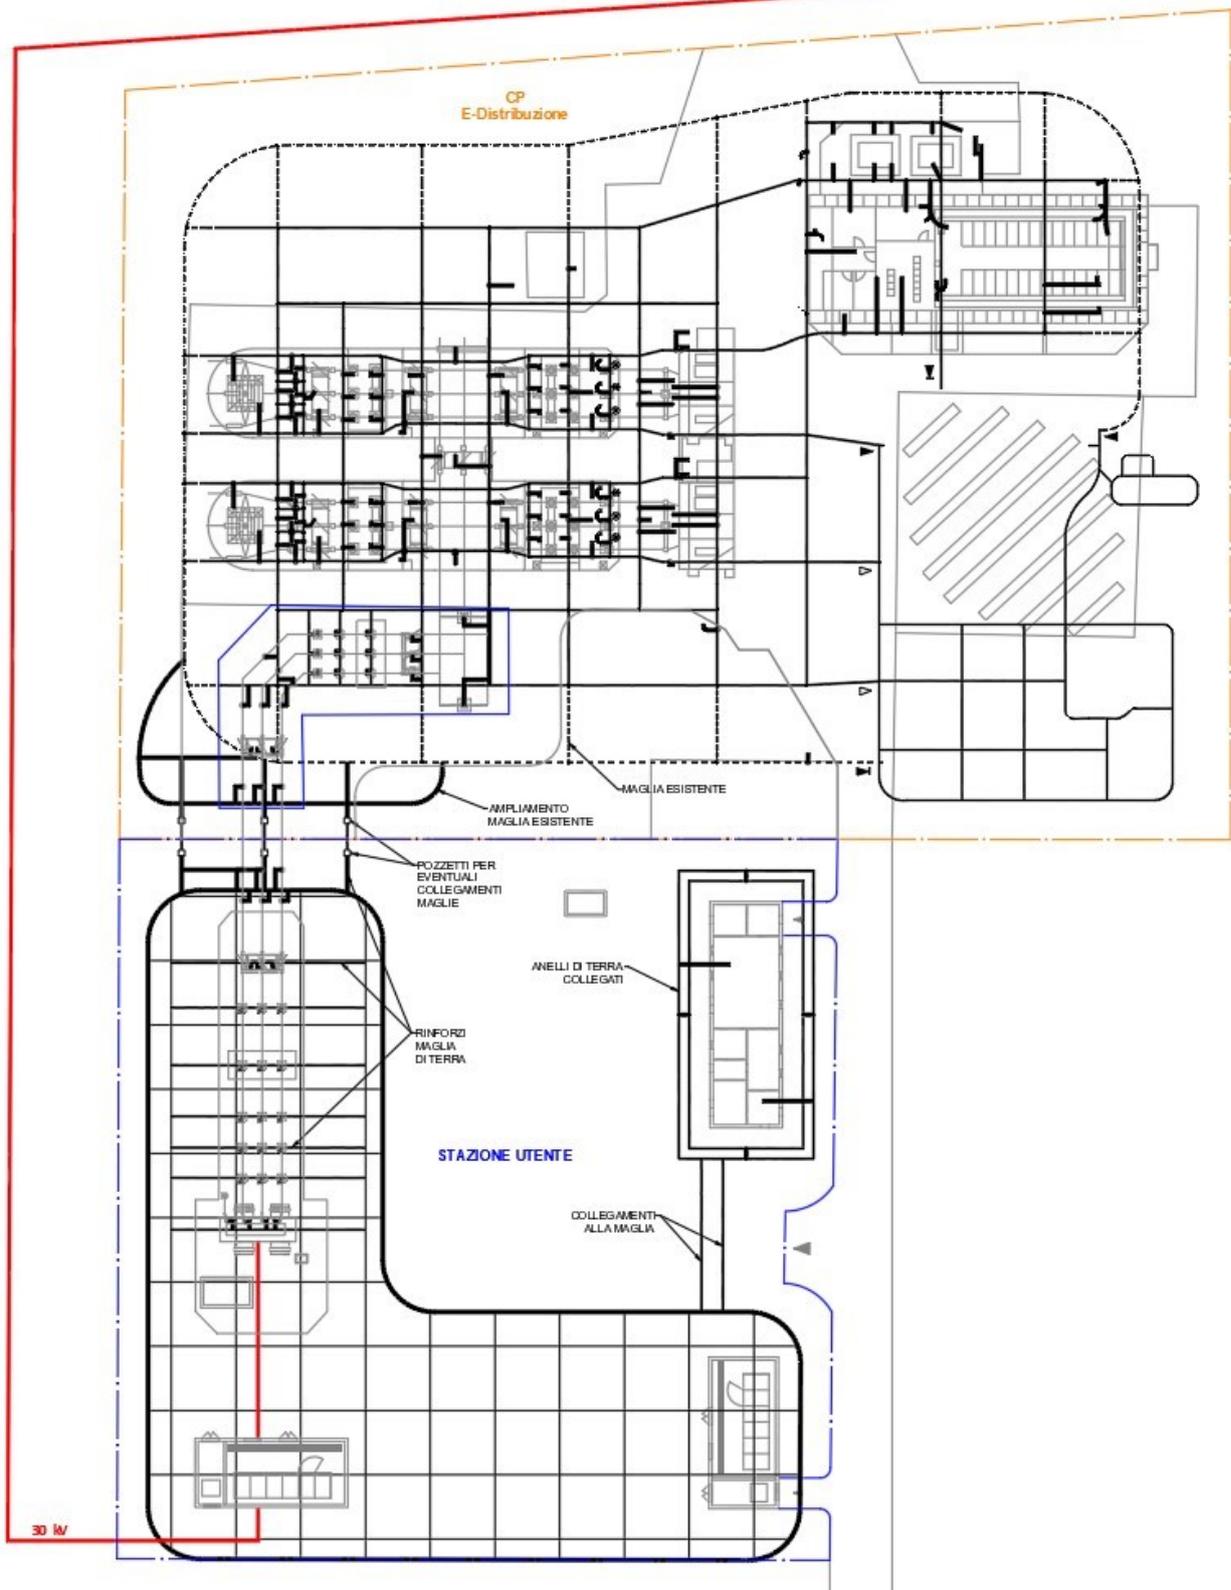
Planimetria con maglia di terra (vedi Tav 4.6 degli allegati)
